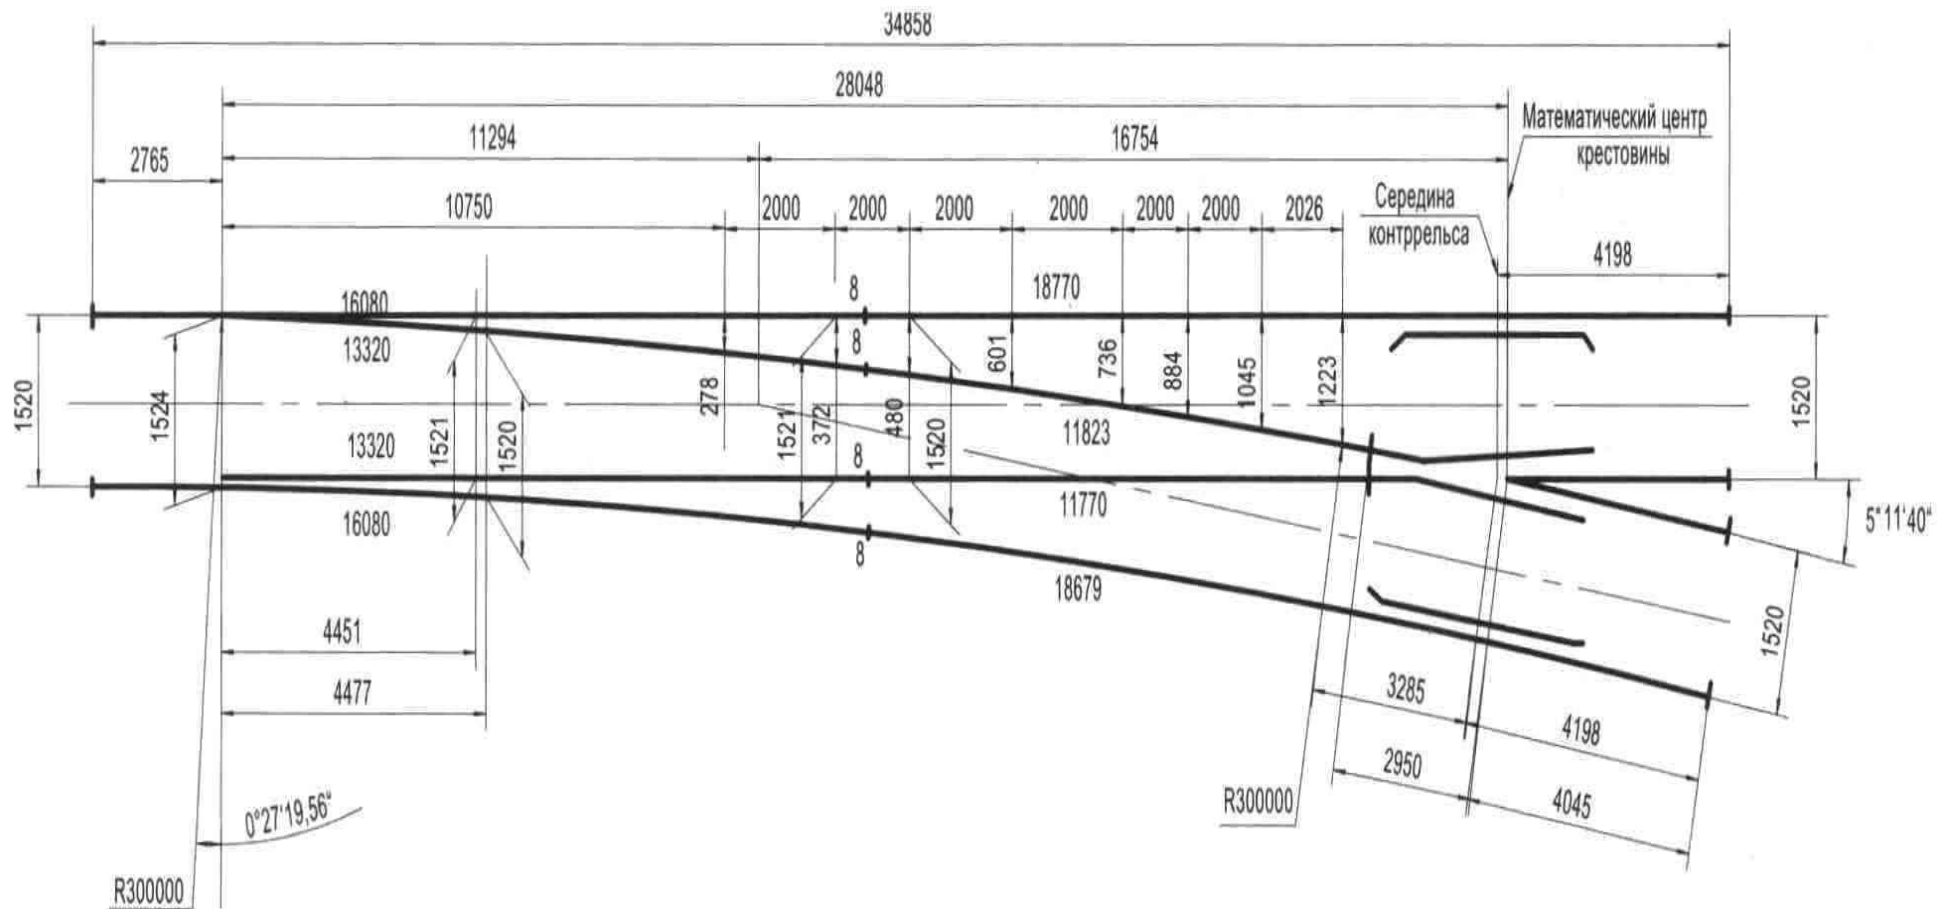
Схема разбивки стрелочного перевода типа Р65 марки 1/11 на железобетонных брусках. Проект 2750
